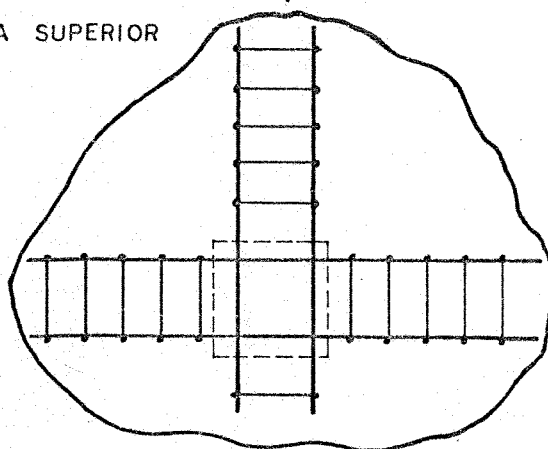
ARMADURAS TRANSVERSAIS
